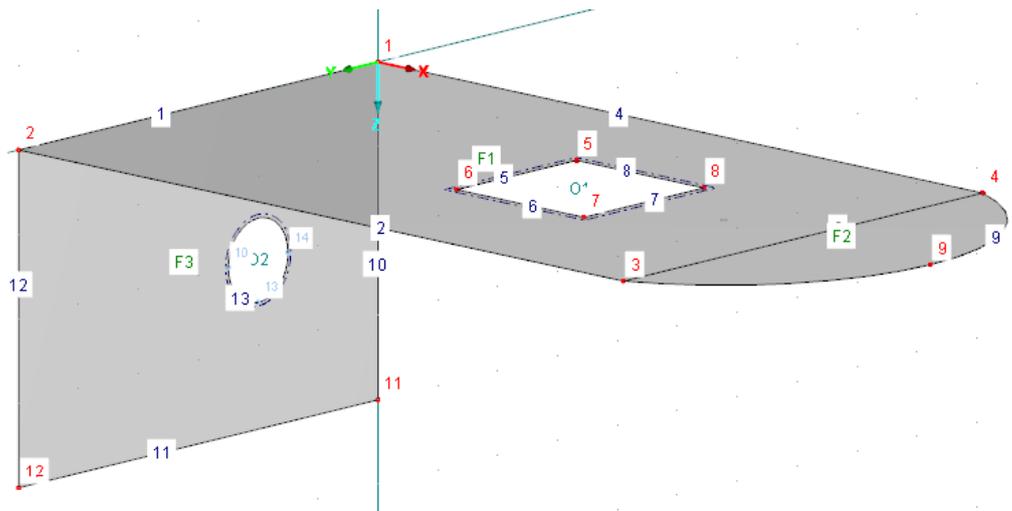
Decken- und Wandflächen mit Öffnungen
